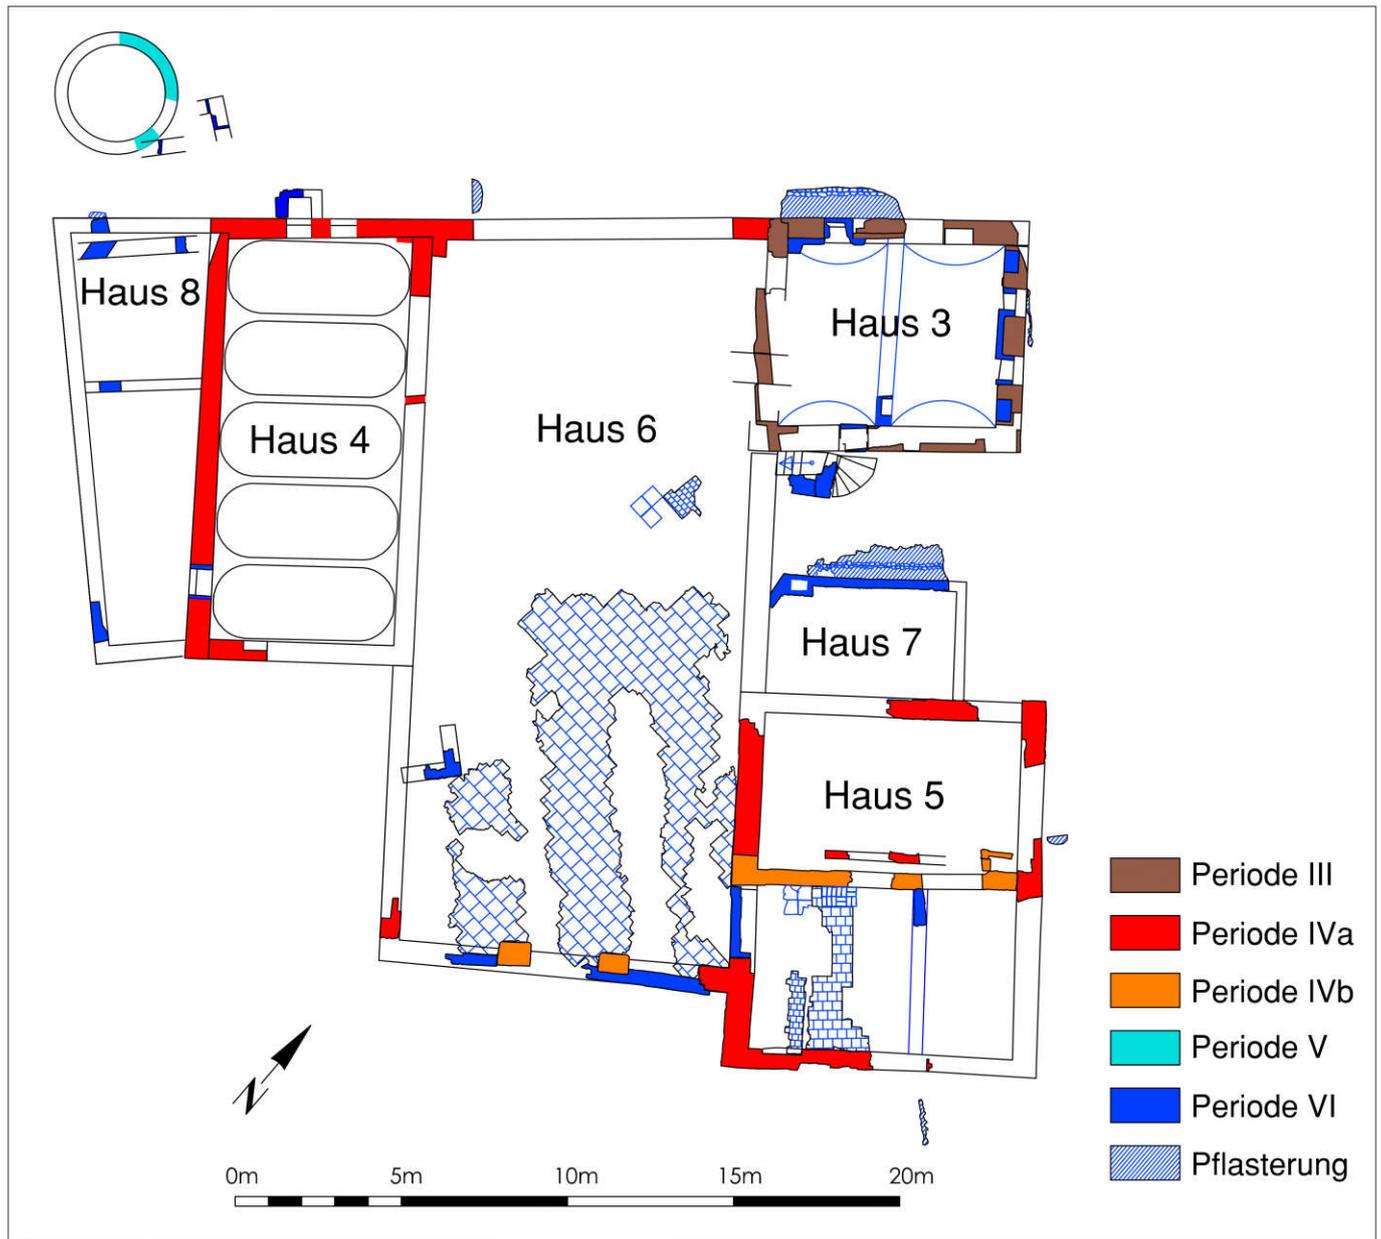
Hansestadt Lübeck, St.-Annen-Straße 13. Grundriss des Ritterhofes mit Ausbauphasen.
